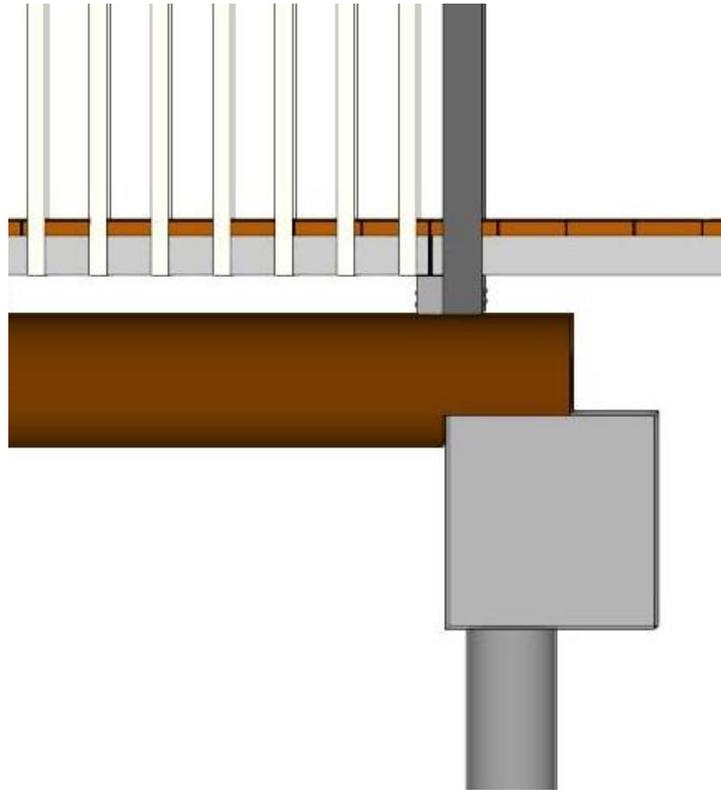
Detalhe do encaixe da viga de madeira no bloco de coroamento da estaca da ponte.
